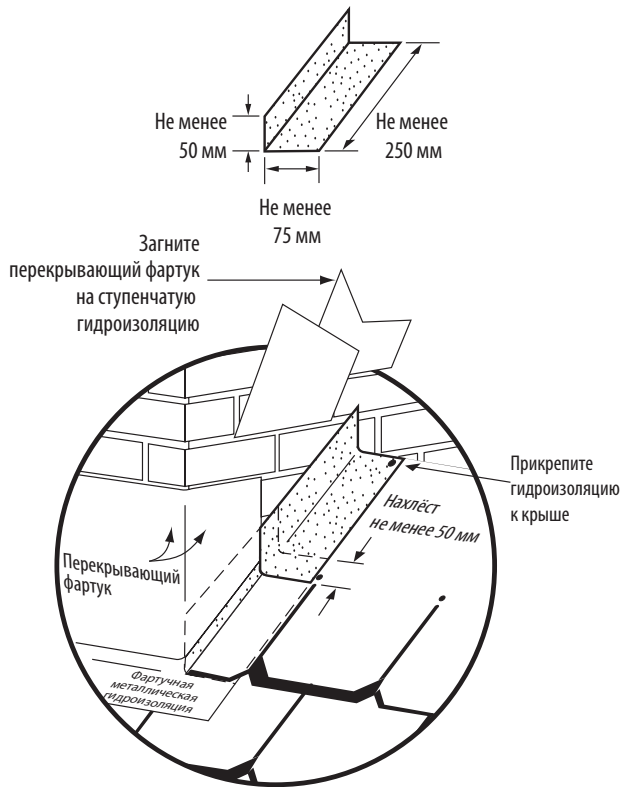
Монтаж ступенчатой металлической гидроизоляции при укладке гонта Grand Manor.
